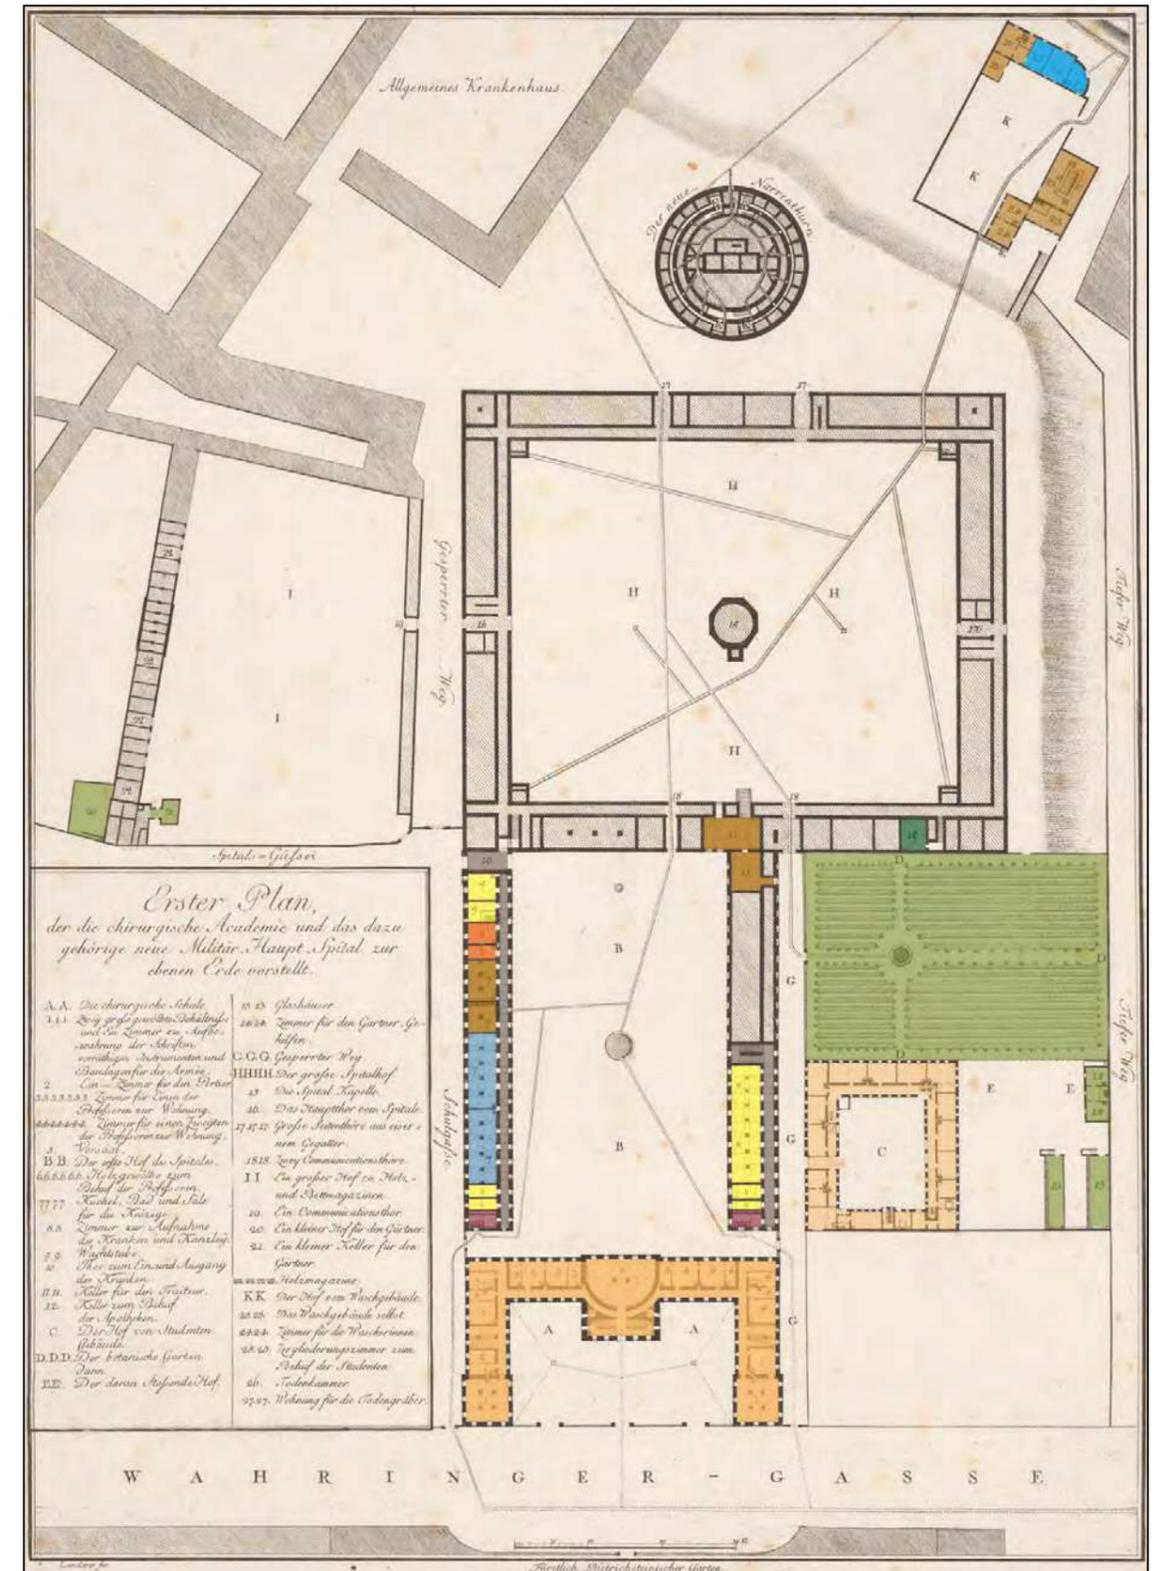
Das Josephinum und das Militärkrankenhaus, Erdgeschoss. Grundriss von Josef Gerl, 1784.
